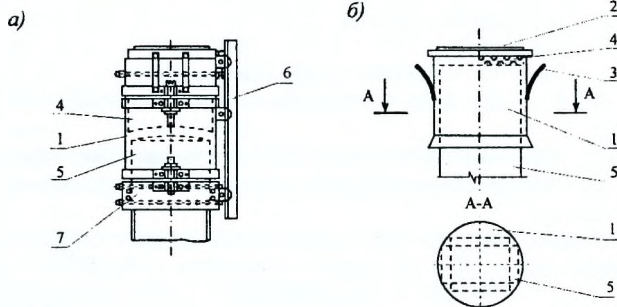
Сварной наголовник с креплением к молоту свободно (а) и жёстко (б):
